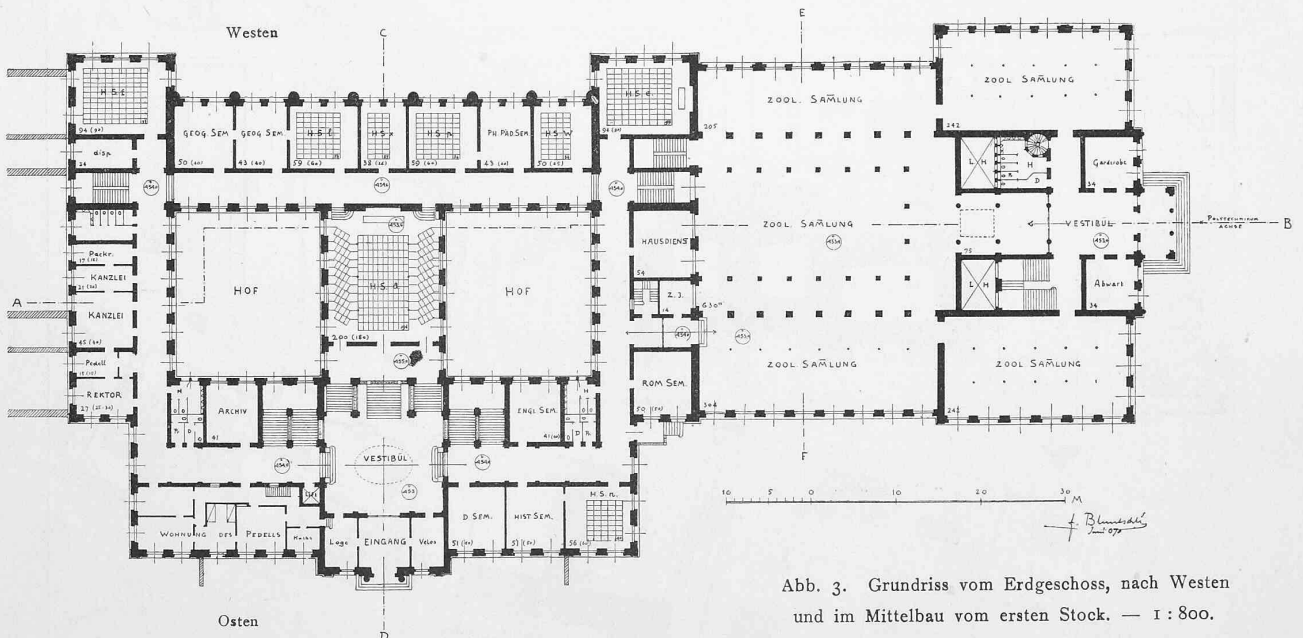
Grundriss vom Erdgeschoss, nach Westen und im Mittelbau vom ersten Stock. — 1 : 800.
